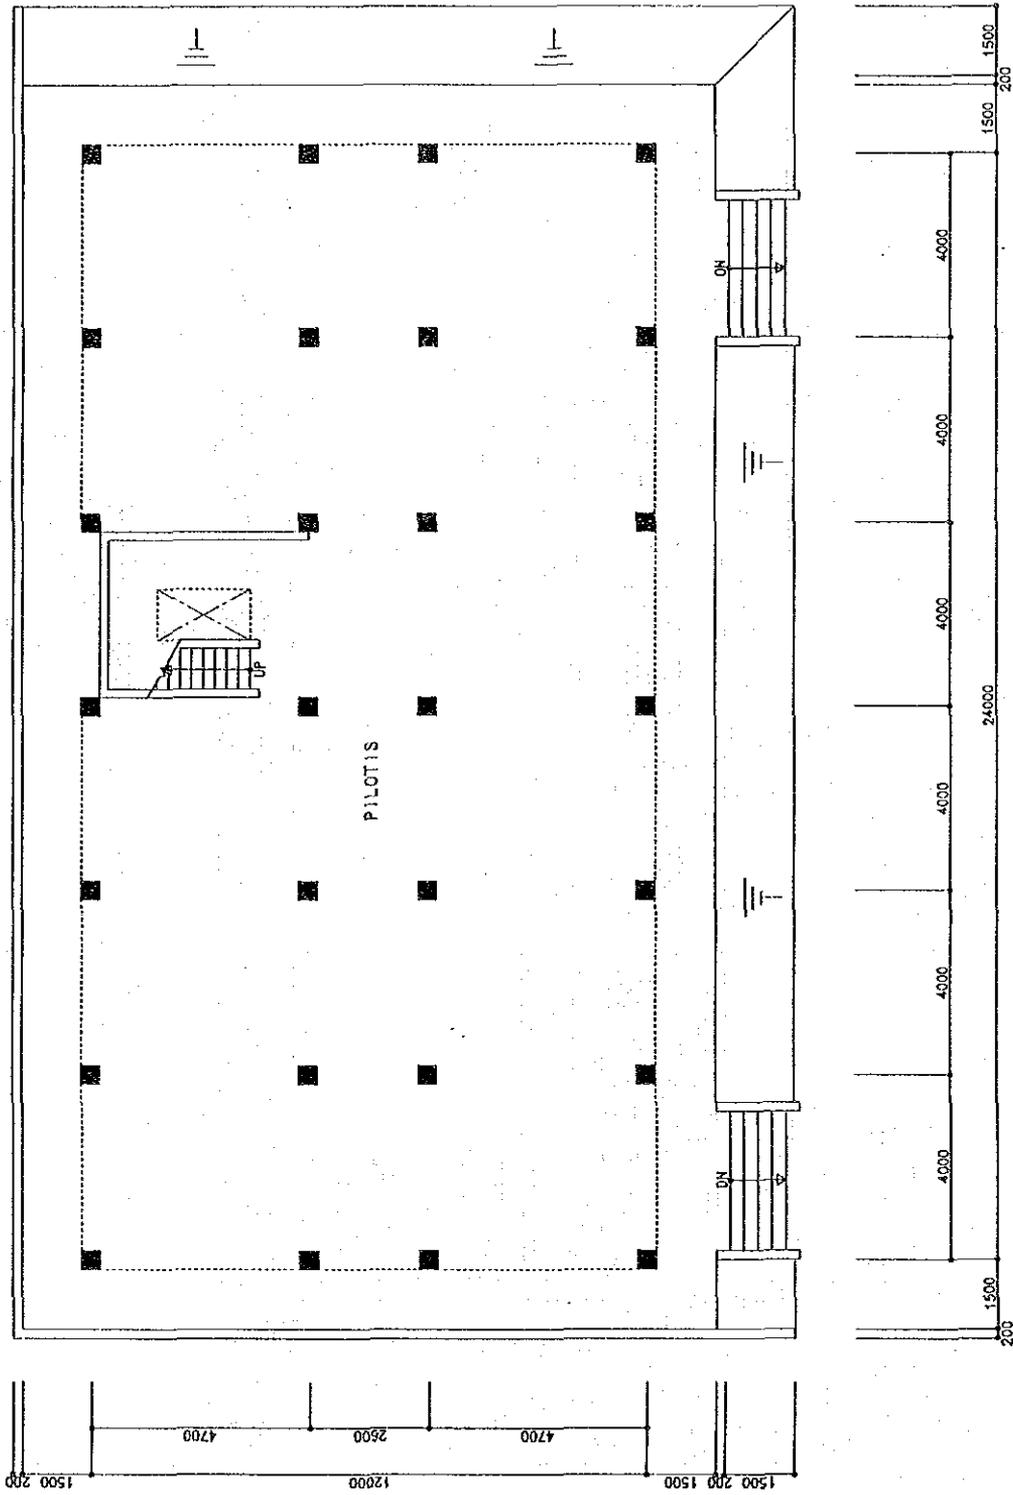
(1) 1 階平面図 (4 教室タイプ)
